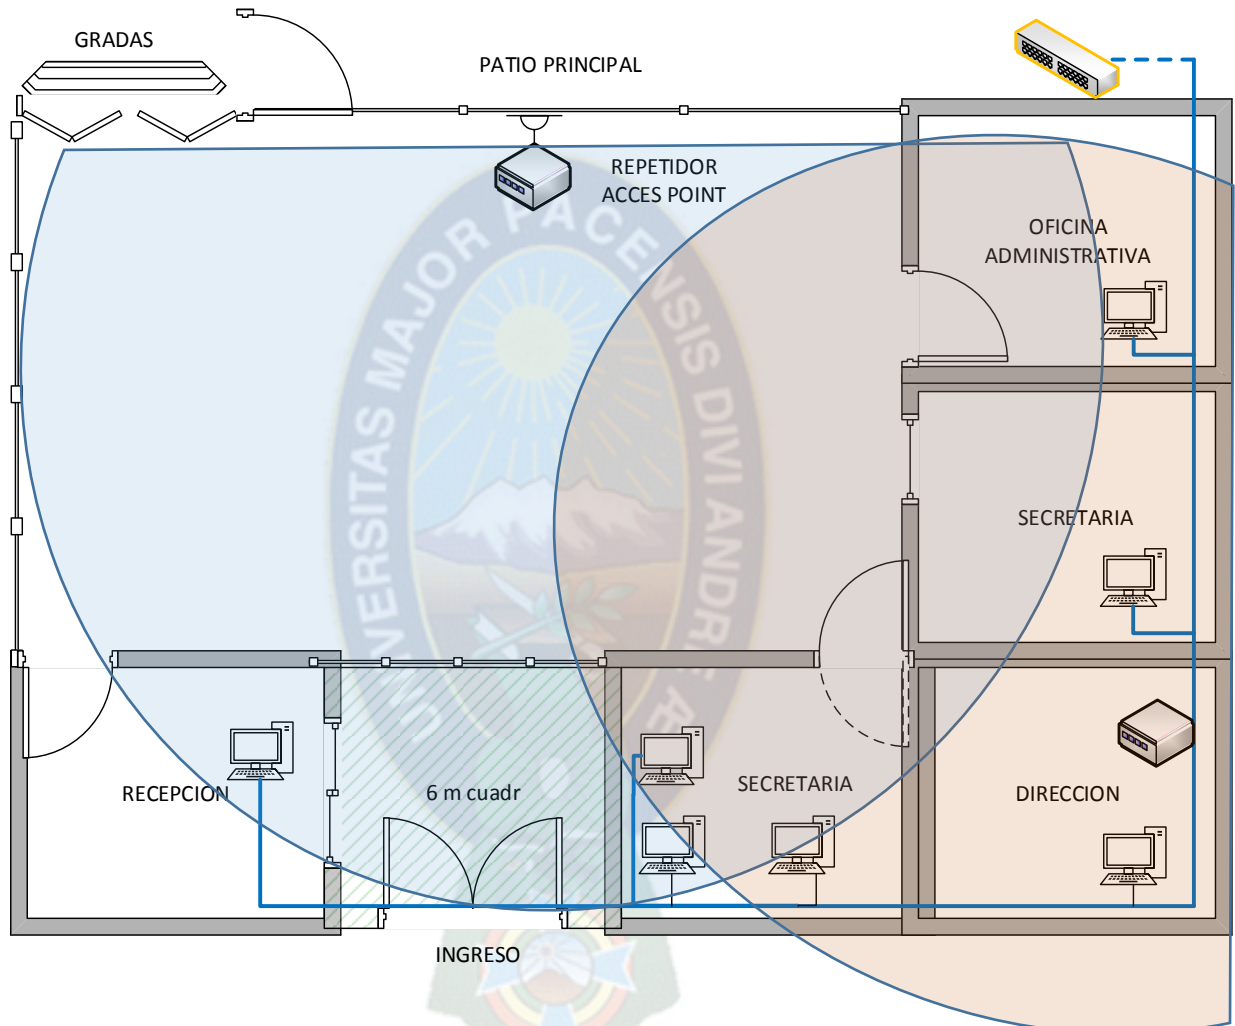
Diseño de plano y distribución de red, planta baja de primer bloque
